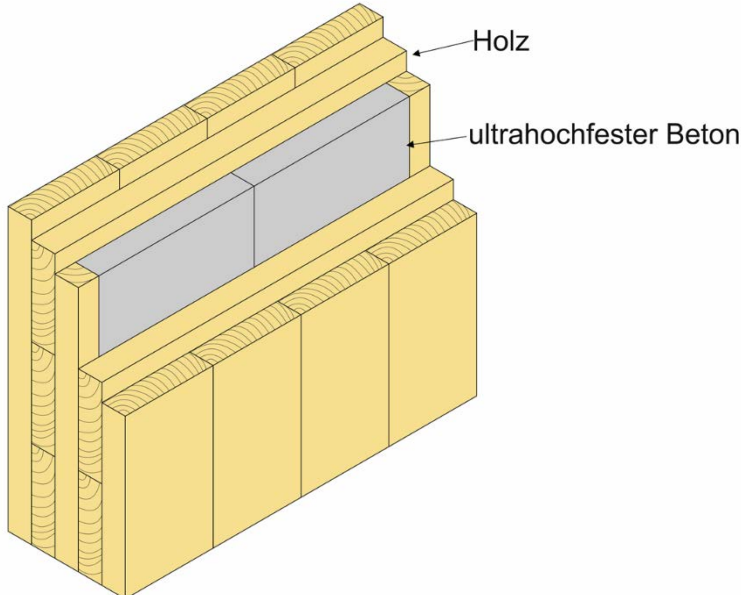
Wandelement mit eingeklebten Lamellen aus ultrahochfestem Beton
